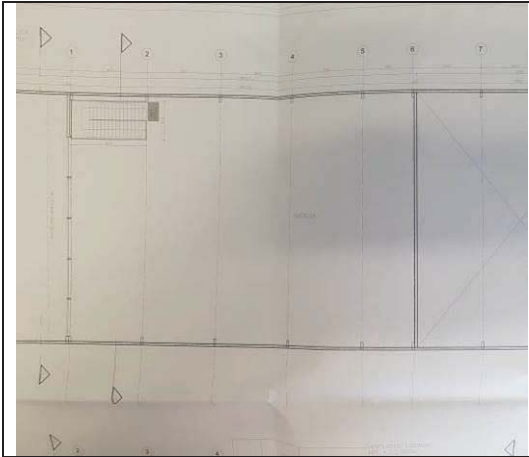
, de 11 de febrero de 2020: Acceso a recintos no informados en la planimetría del 2° nivel, del permiso de edificación N°11, de 2019.
